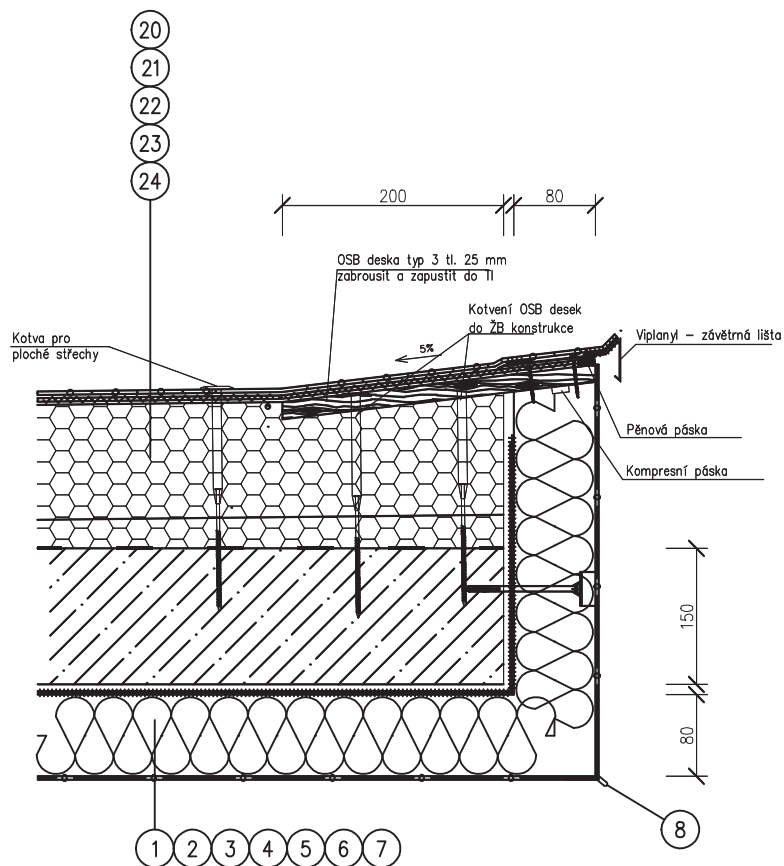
DETAIL ZATEPLENÍ U ATIKY – PŘÍSTAVBA
